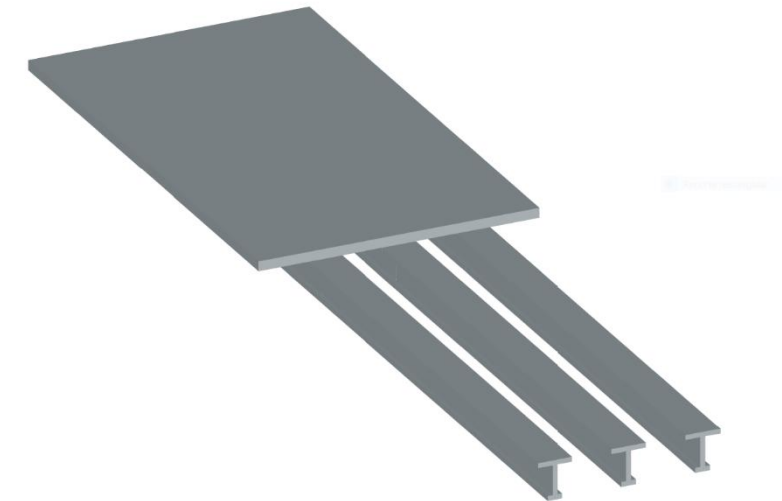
Boceto pasarela de vigas de hormigón (FUENTE: Elaboración propia).
